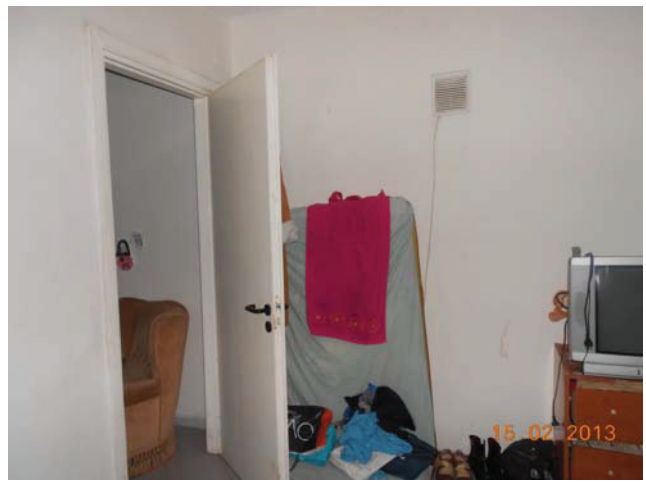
, 4 : Camera da letto (si noti che la finestra dall'interno è di dimensioni normali, dall'esterno tuttavia è parzialmente murata, vedi foto 1)
